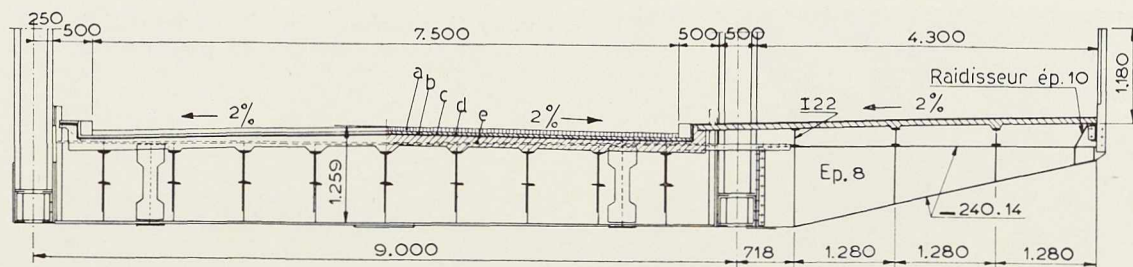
Coupe transversale du nouveau pont-route de Tulln.
